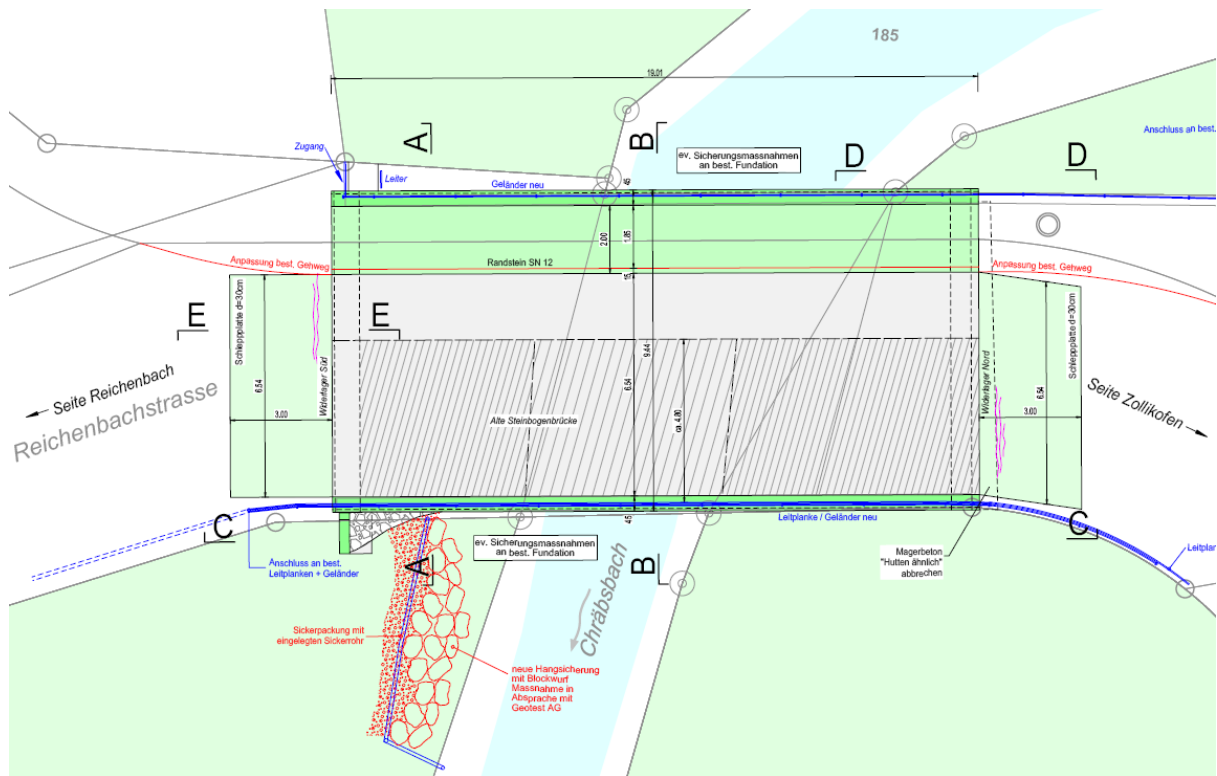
Draufsicht Sanierung Reichenbachbrücke
